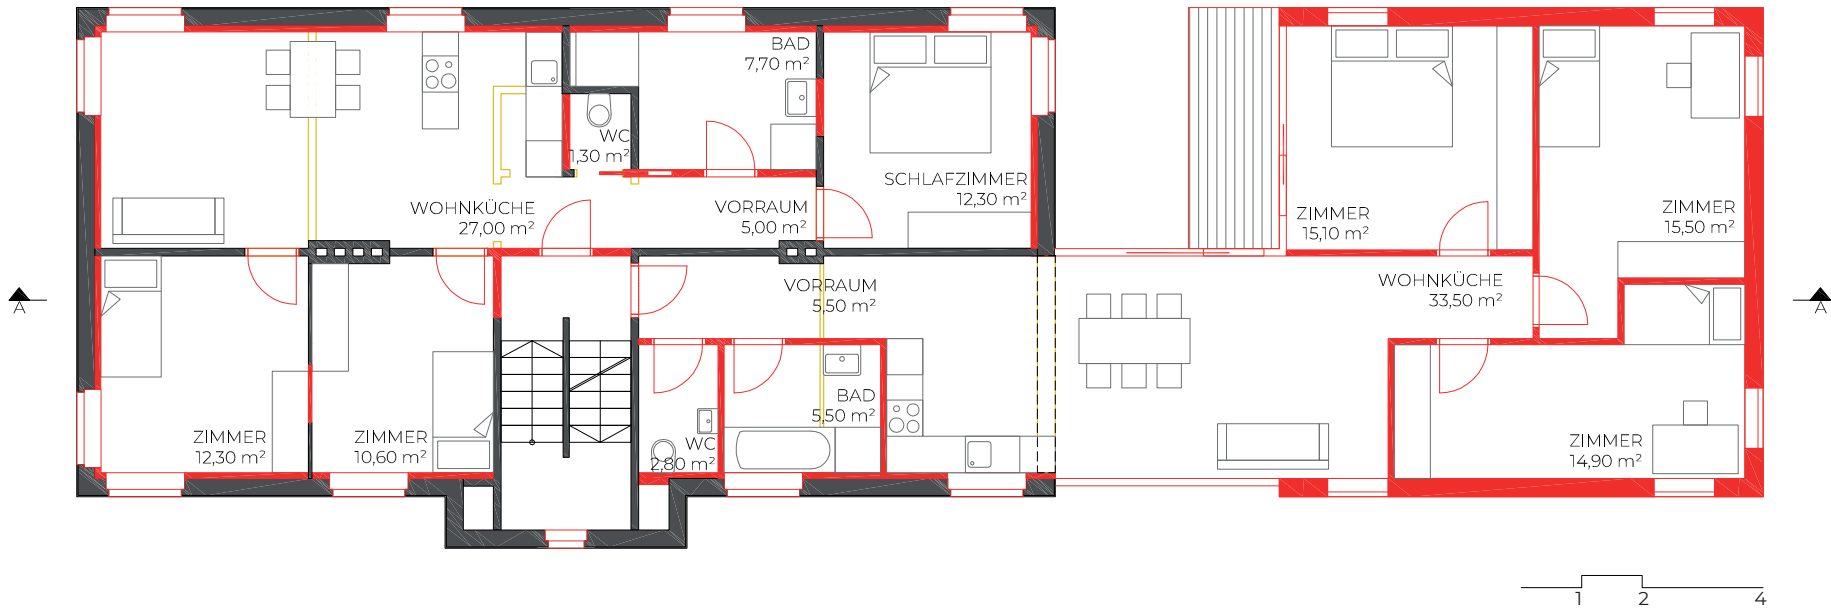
Grundriss Bestandsgebäude Umbau mit Zubau Rückseite, OG
